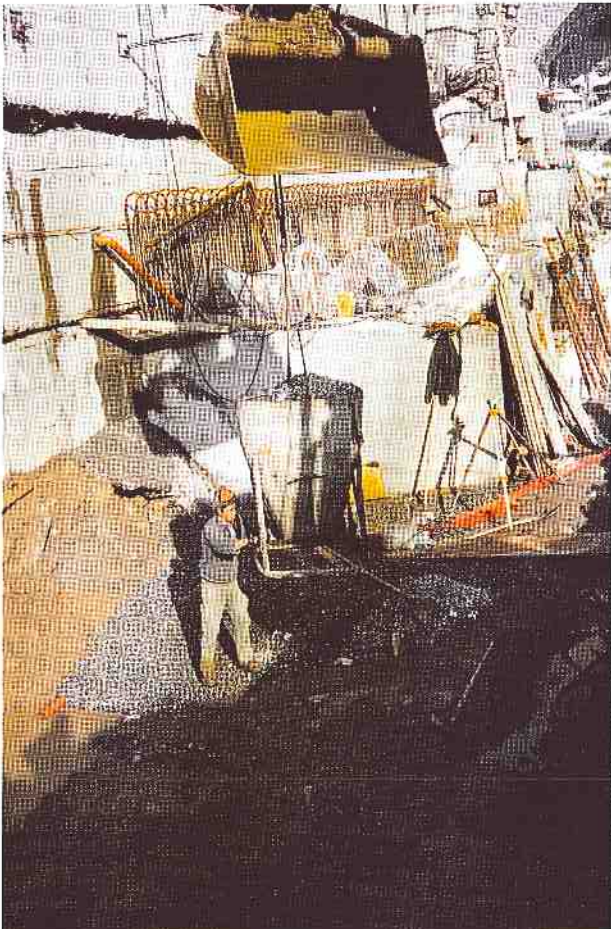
Entwässerung Fundamentbereich mit Sickerleitung, Sickerkies und Entwässerungsgraben.
